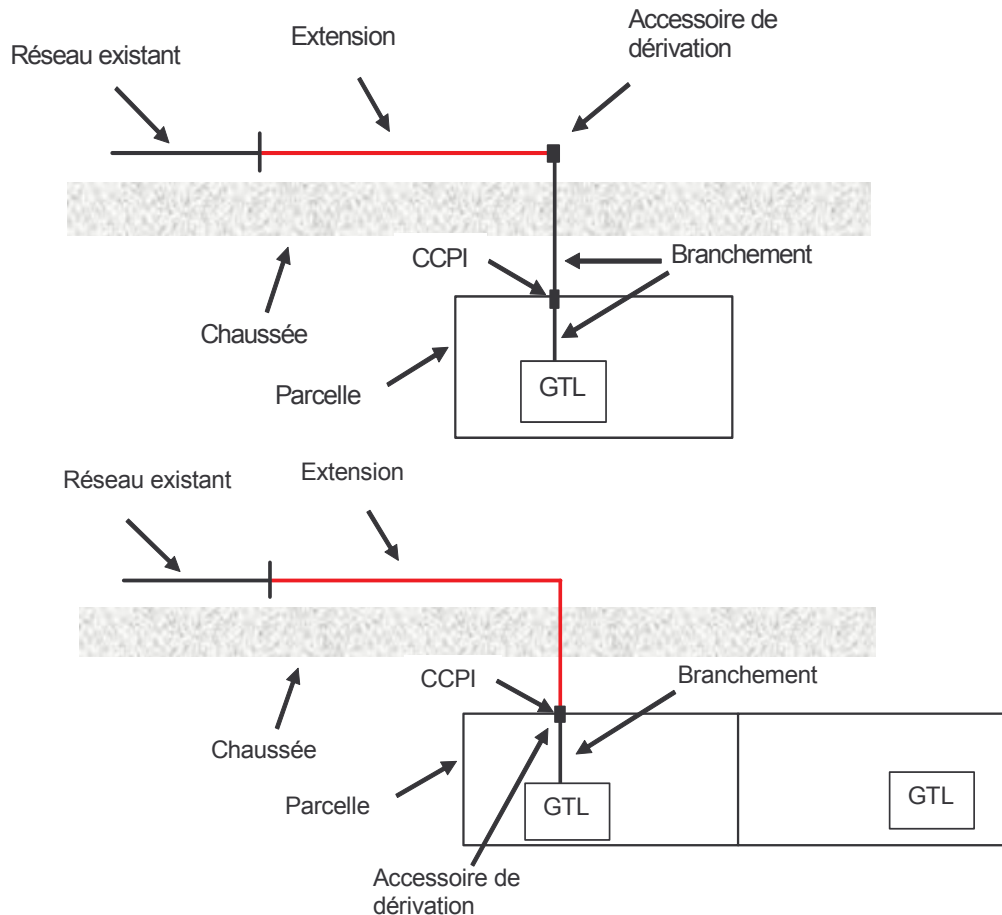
raccordement individuel BT ≤ 36 kVA avec extension et traversée de chaussée
